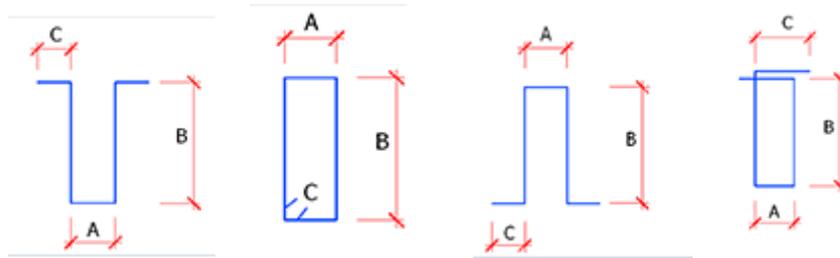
Tipos de armaduras en el alma.
